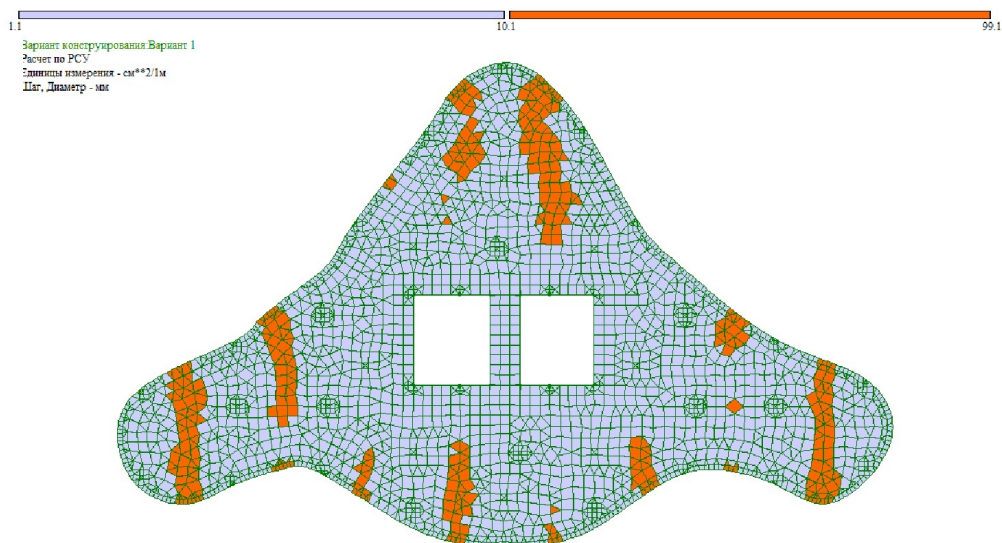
Армирование перекрытия (Нижняя по X)
